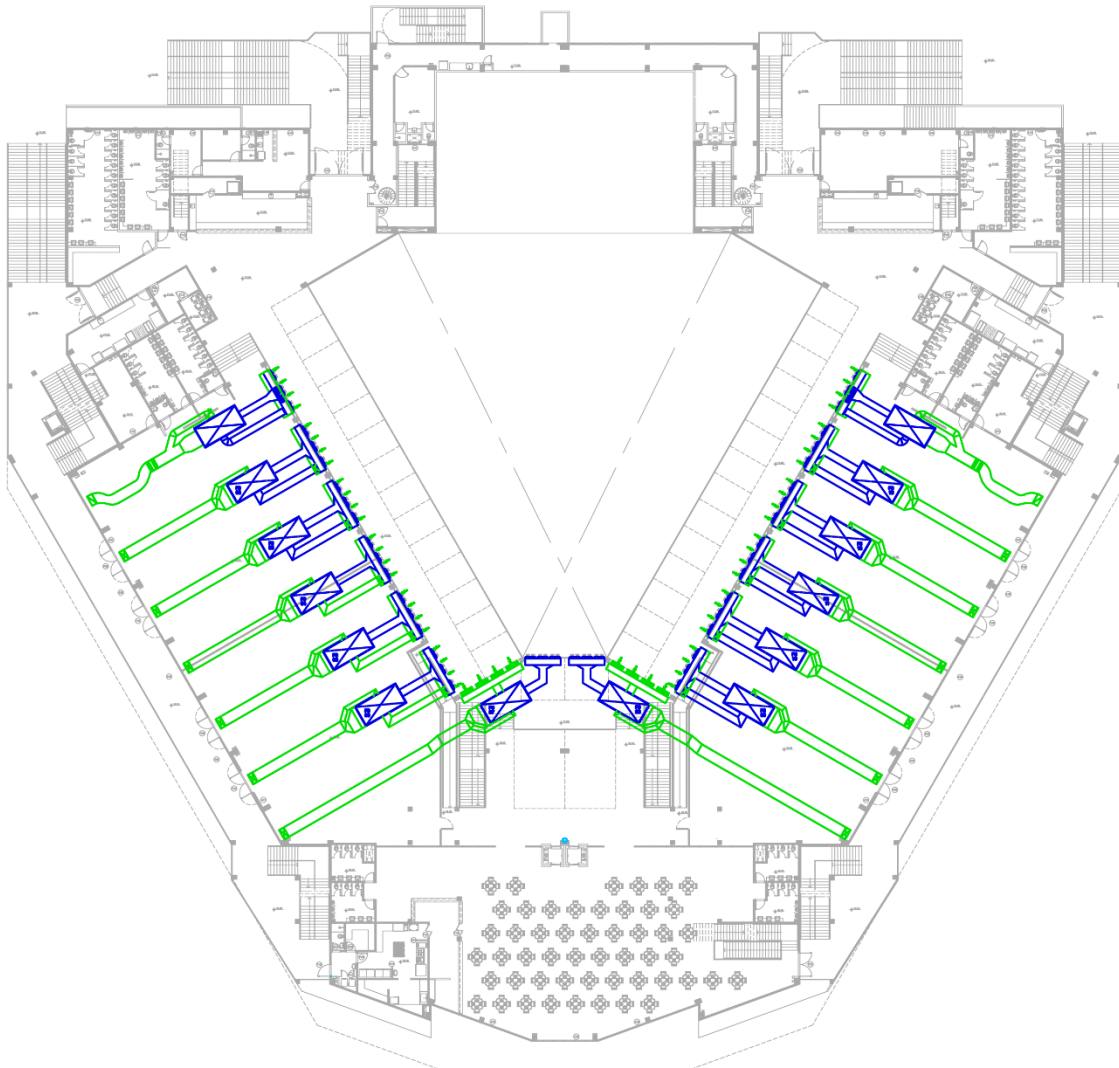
Projeto de Climatização: Planta Baixa do T erreo (sem escala)
